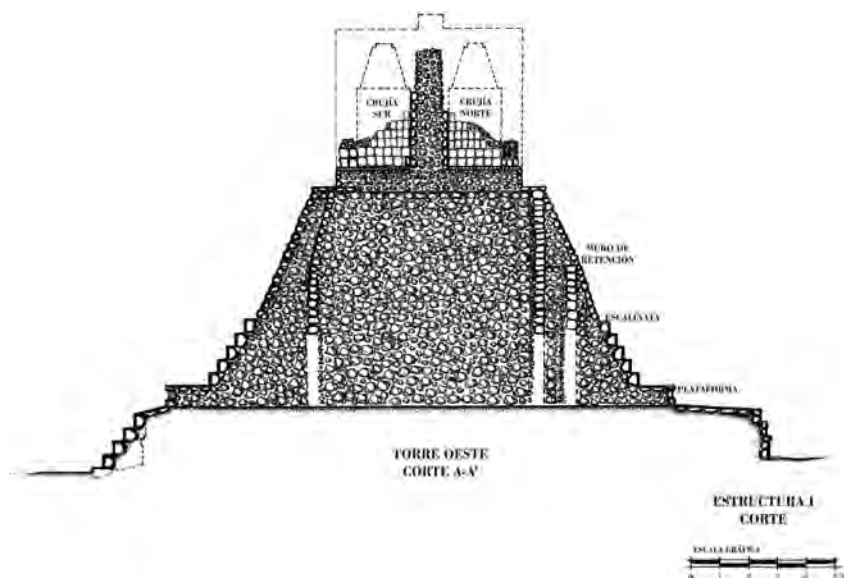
Corte oeste de la torre oeste al concluir su liberación y restauración. A través del dibujo se puede ver su sistema constructivo y arquitectónico empleado en su elaboración por los antiguos mayas.
